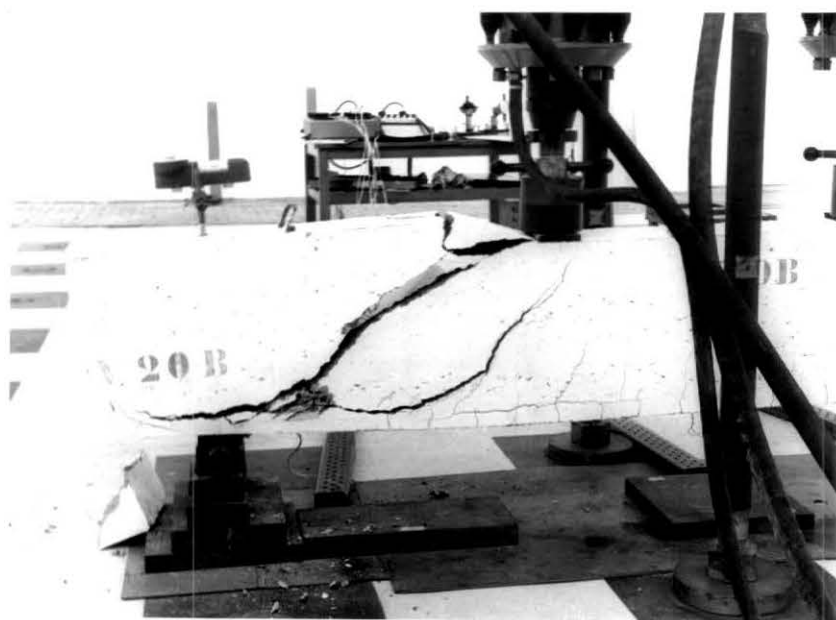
Detalhe da ruptura da viga 20B devido à compressão excêntrica.
